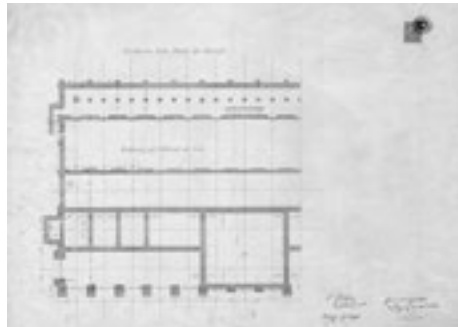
Tiro al Bersaglio. Pianta delle fondazioni, 6 luglio 1865 (ASCT, Tipi e disegni, 21.3.41).
